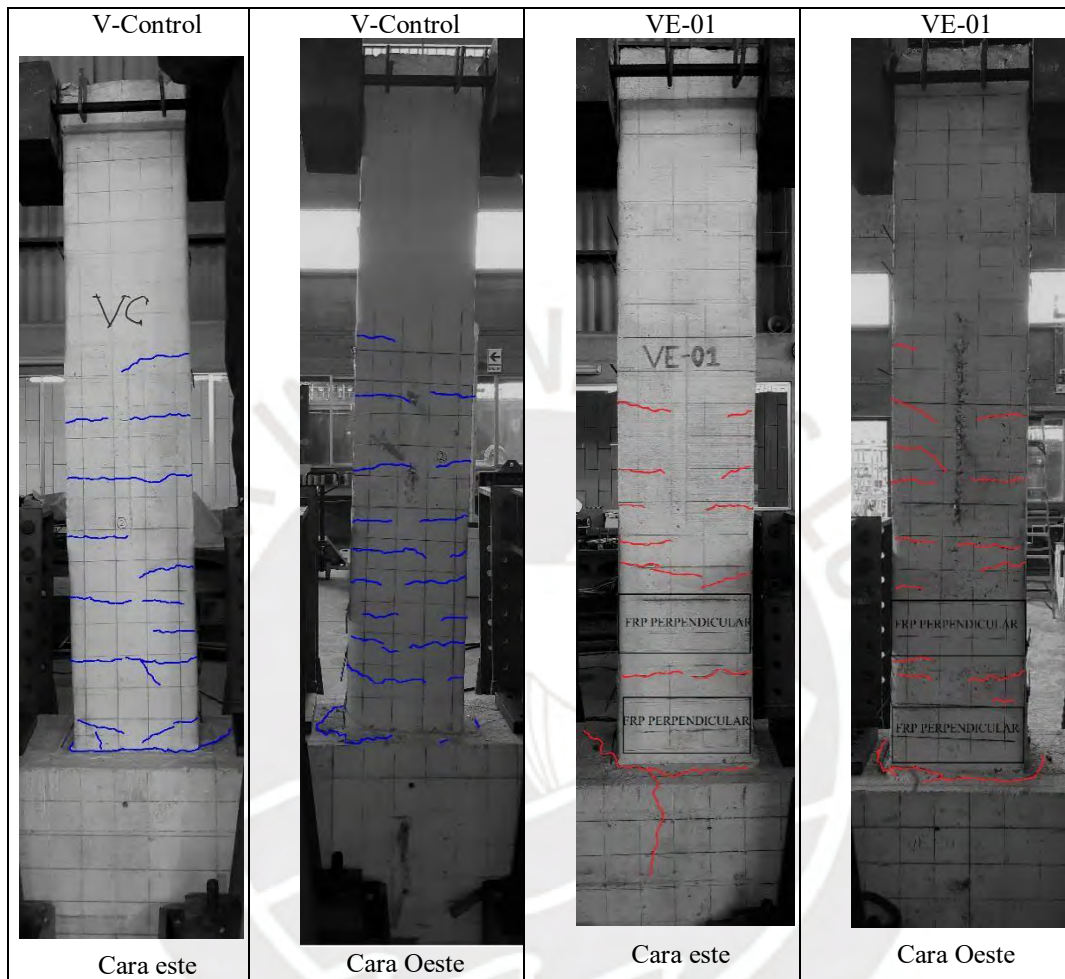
Agrietamiento Viga de control y VE-01 (Fuente: Propia)
